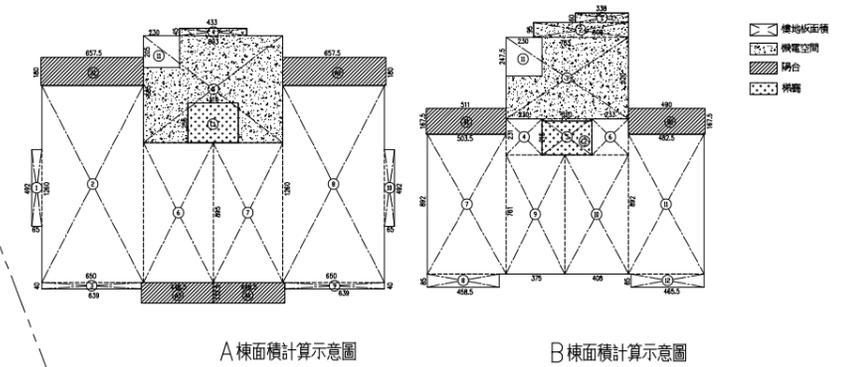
三層~十三層，十五層至二十三層平面圖 (S: 1/200)
